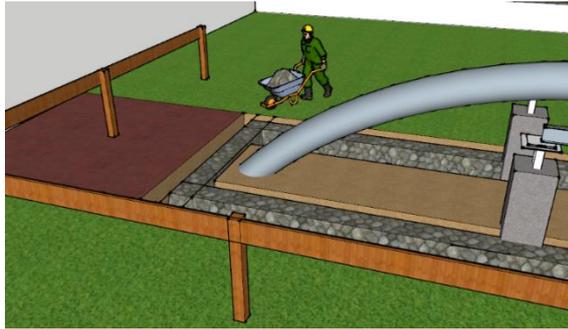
Benang sebagai Acuan *Leveling* Pondasi
